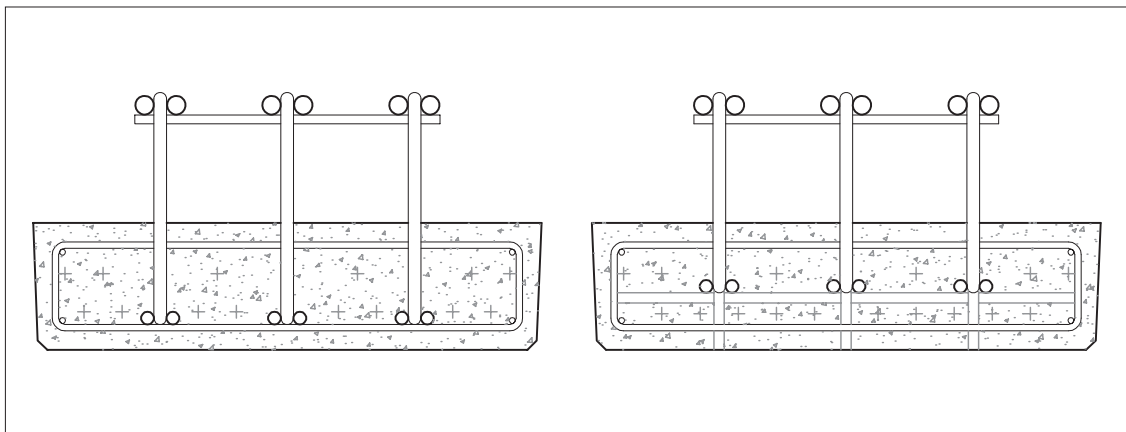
Travi con fondello in calcestruzzo precompresso a cavi aderenti.
